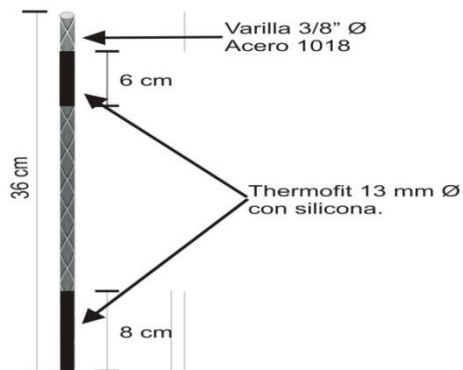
Acondicionamiento de la varilla para ser embebida en las vigas de concreto, con un área de exposición de 60 cm^2 .
